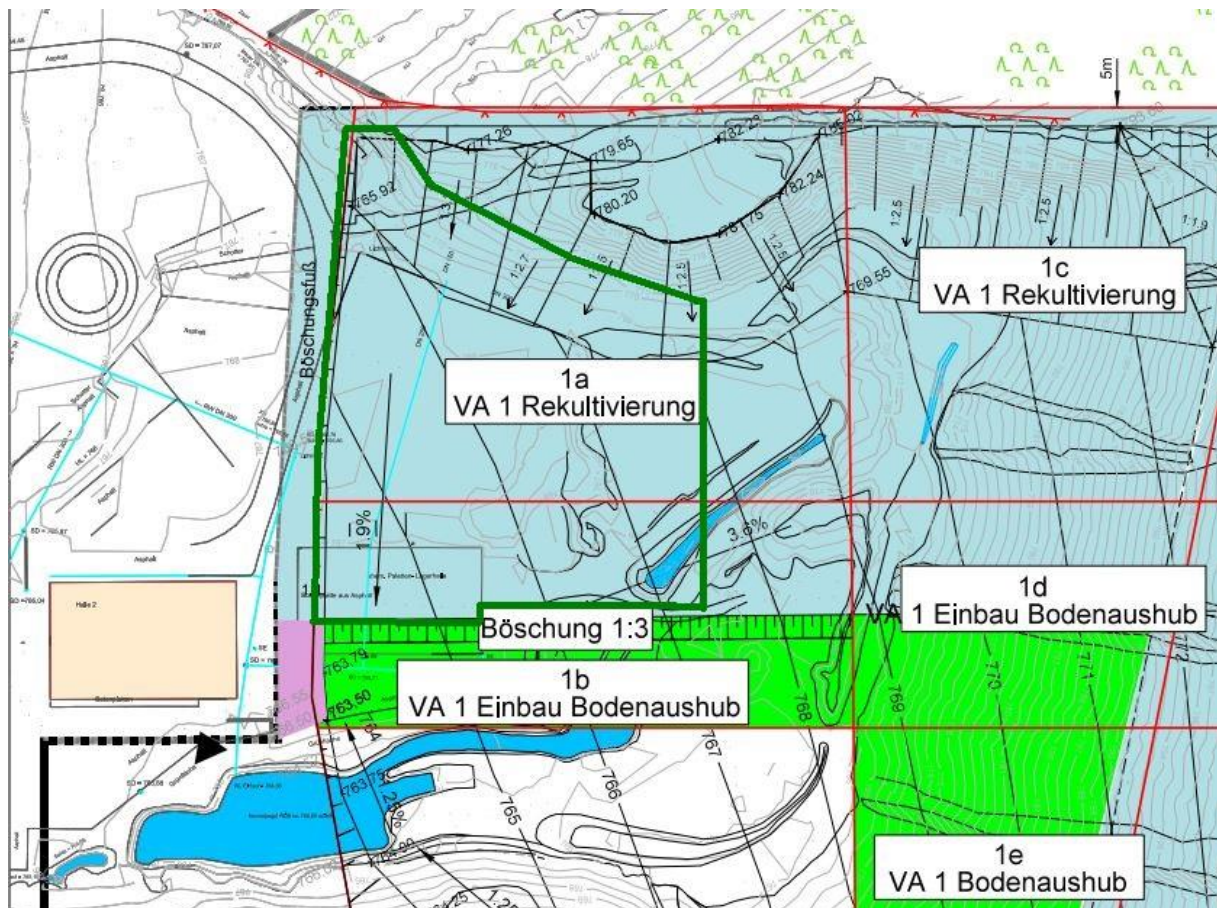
Auszug aus dem Lageplan Basisabdichtung Variante 2 Phase 2 (Große Deponie), geplante Rekultivierungsfläche zur Kompensation der RC-Anlage: grüne Umrandung, Maßstab 1 : 1 : 000
